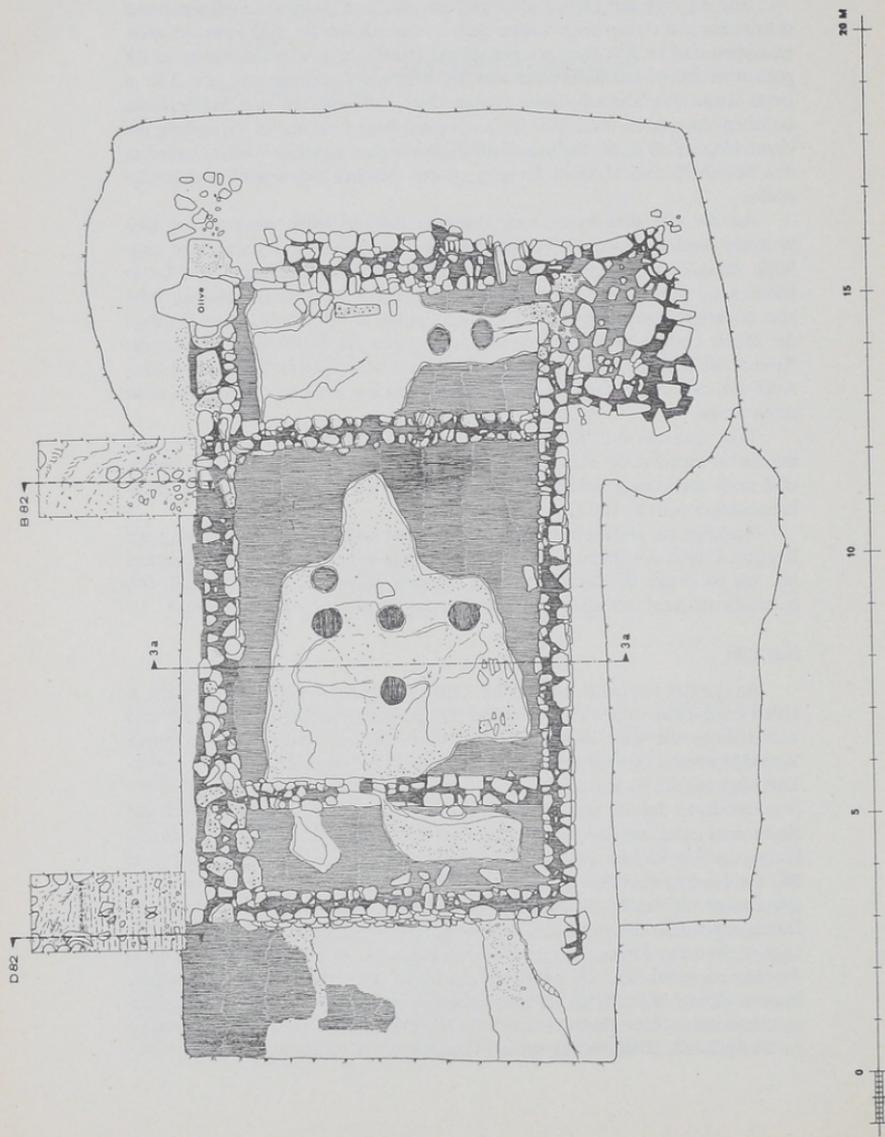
Bau II. Grundriss, M 1:100.
